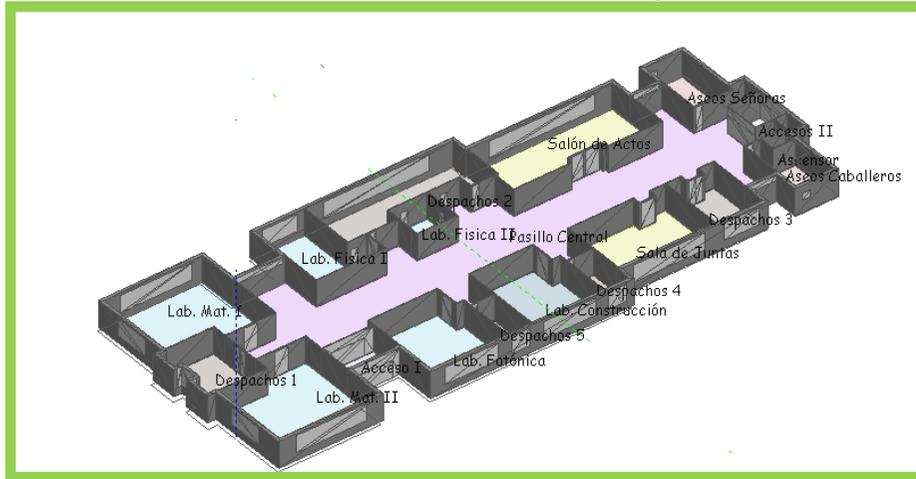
Planta 1 del Pabellón de Arquitectura Técnica.
